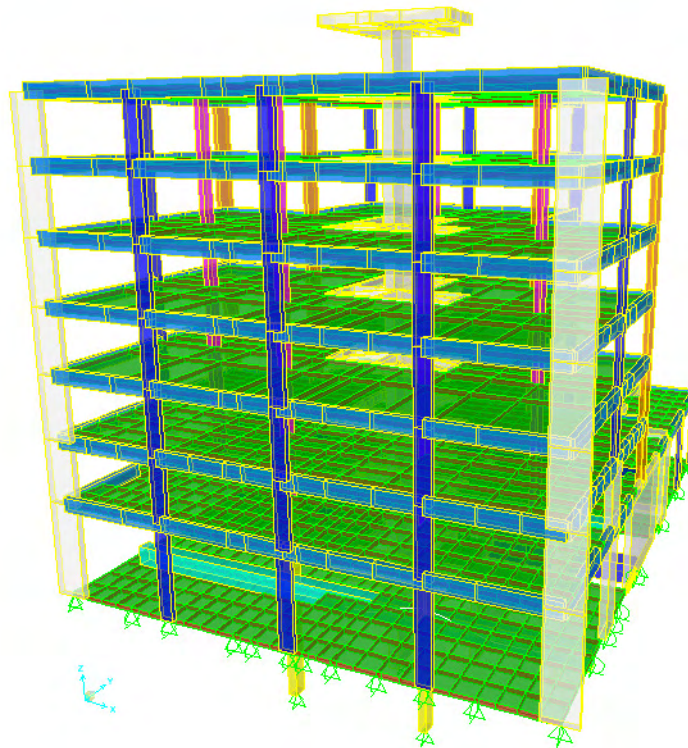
Modelo Global – Vista da fachada principal e empena direita
